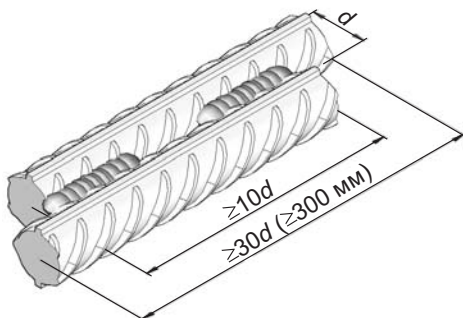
Контрольный образец нахлесточного соединения
